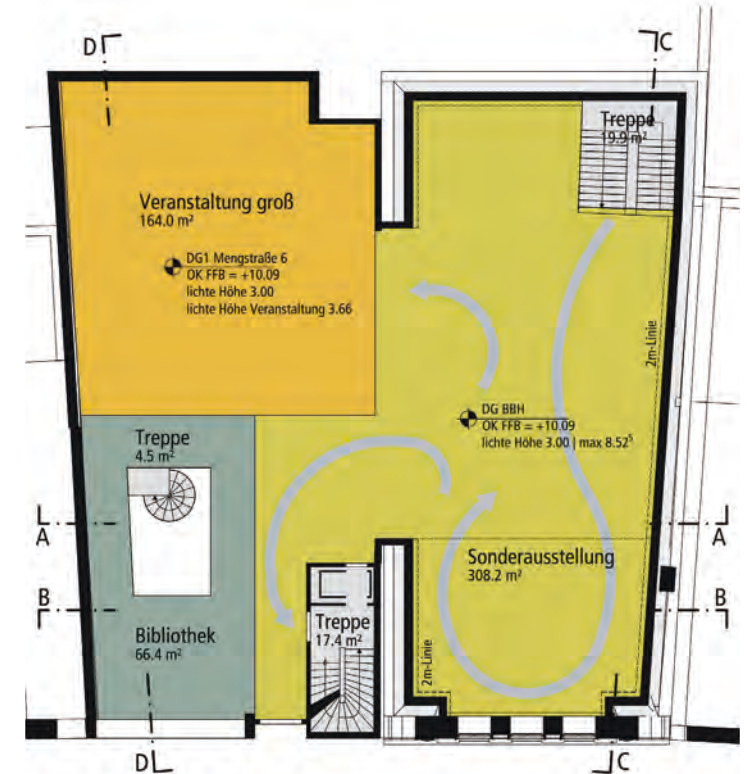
Variante 3, Grundriss Dachgeschoss
